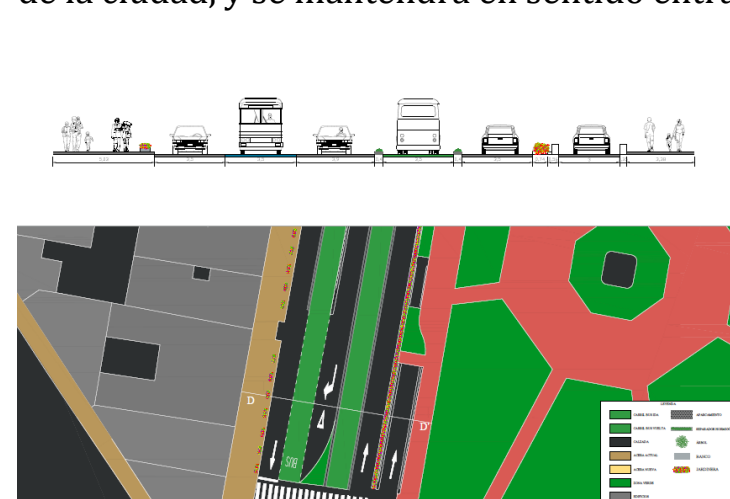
Planta y sección de la calle Sánchez Bregua.
